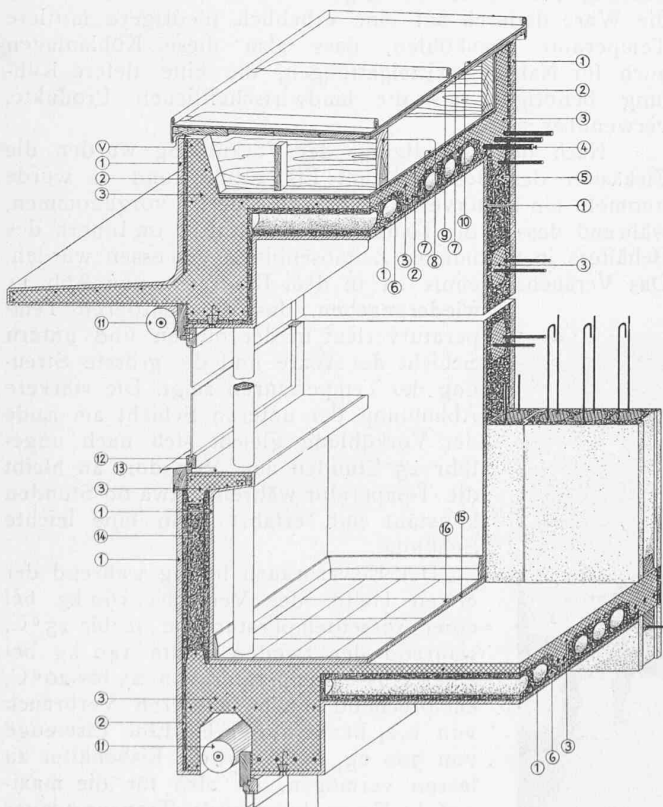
Konstruktions-Schema. — 1 Verputz, 2 Korkplatten, 3 Beton, 4 Armierung, 5 Baukork-Wandsteine, 6 Baukork-Deckensteine, 7 Dachpappen, 8 Schifter, 9 Schalung, 10 Kupferblech, V Luftschlitz zur Ventilation, 11 Rolladen, 12 horizontales Schiebefenster, 13 Linolbelag auf Betonsims, 14 Baukork-Betonsäulen, 15 Estrich, 16 Korkparkett.
